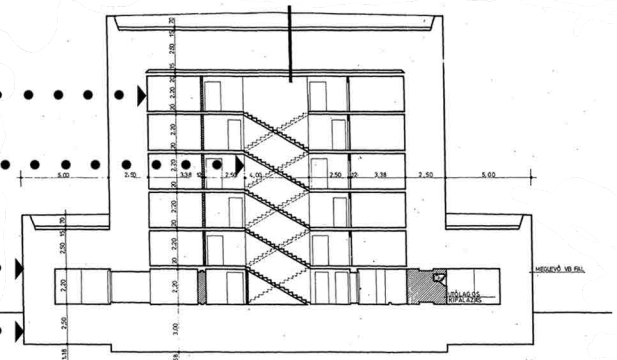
Grundrisse und Schnitt des Bunkers
